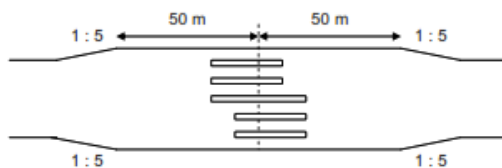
Ruang Bebas Pada Gerbang Tol
